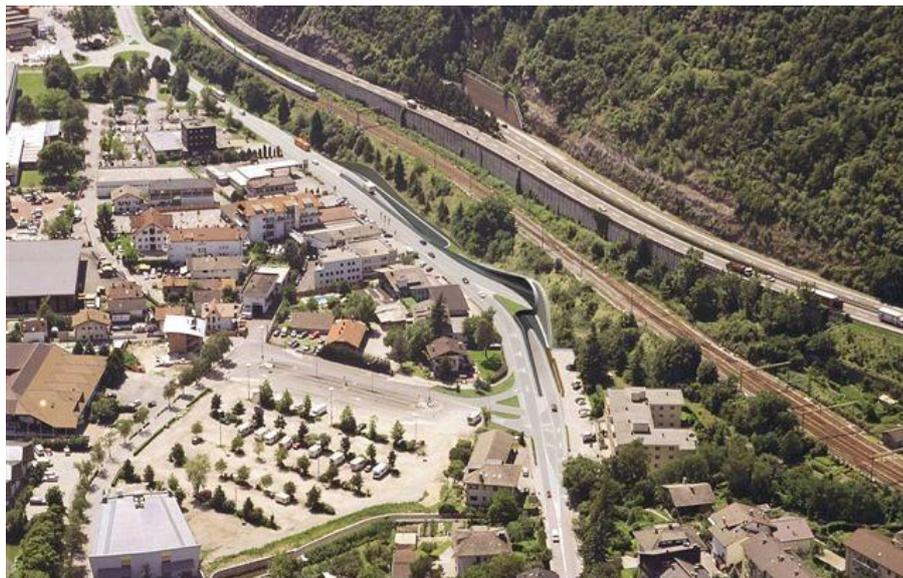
SS 12 - Umfahrung Brixen: Südportal, Südtunnel mit Unterführung, Eisenbahnlinie und Autobahn A22 (Fotomontage). Quelle: Website der Autonomen Provinz Bozen, <http://www.provincia.bz.it/infrastrutture/progettazione/760.asp>.
